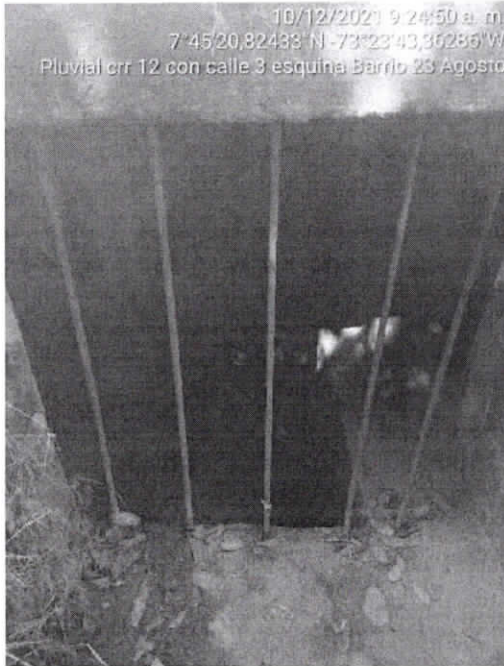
Alcantarillado Pluvial Crr 11 con calle 3, barrio 23 de Agosto.
